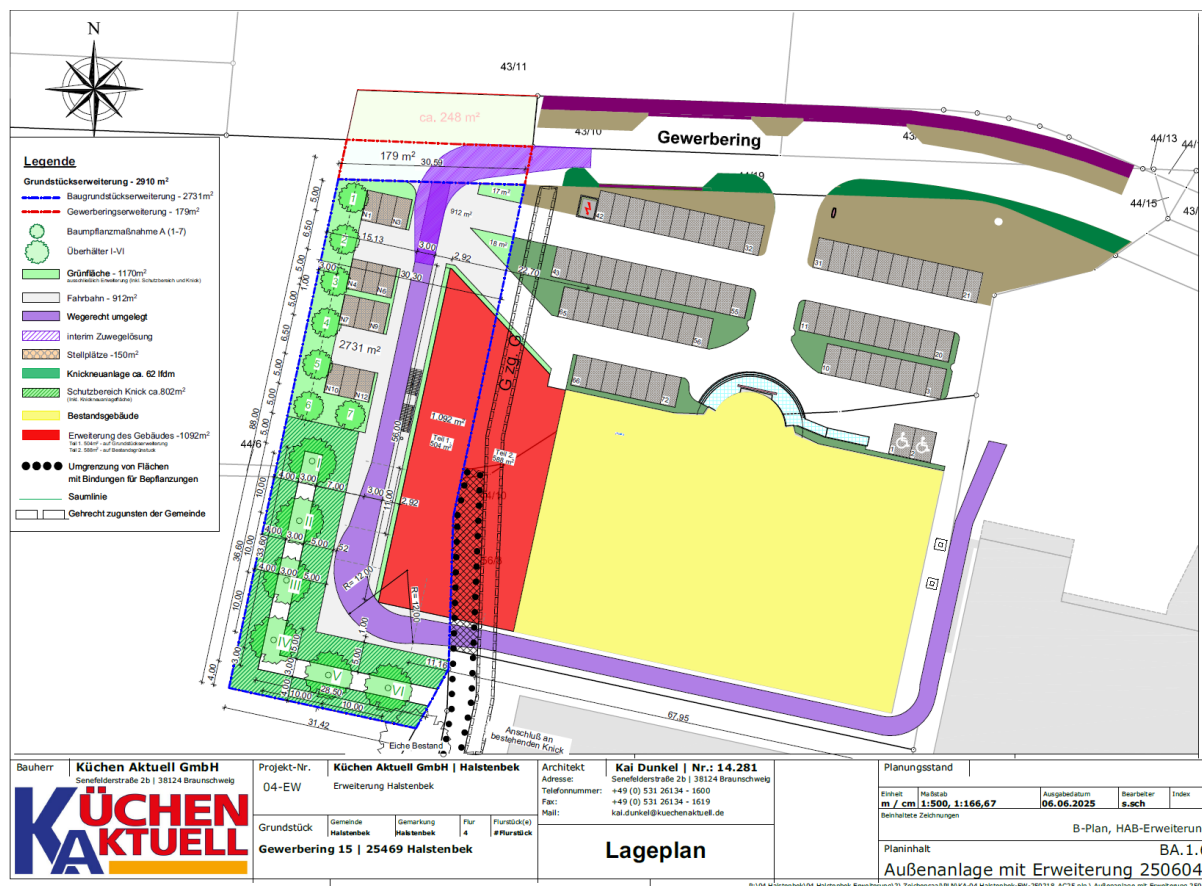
Lageplan mit geplanter Bebauung und Außenanlagen (Quelle: Küchen Aktuell GmbH)
